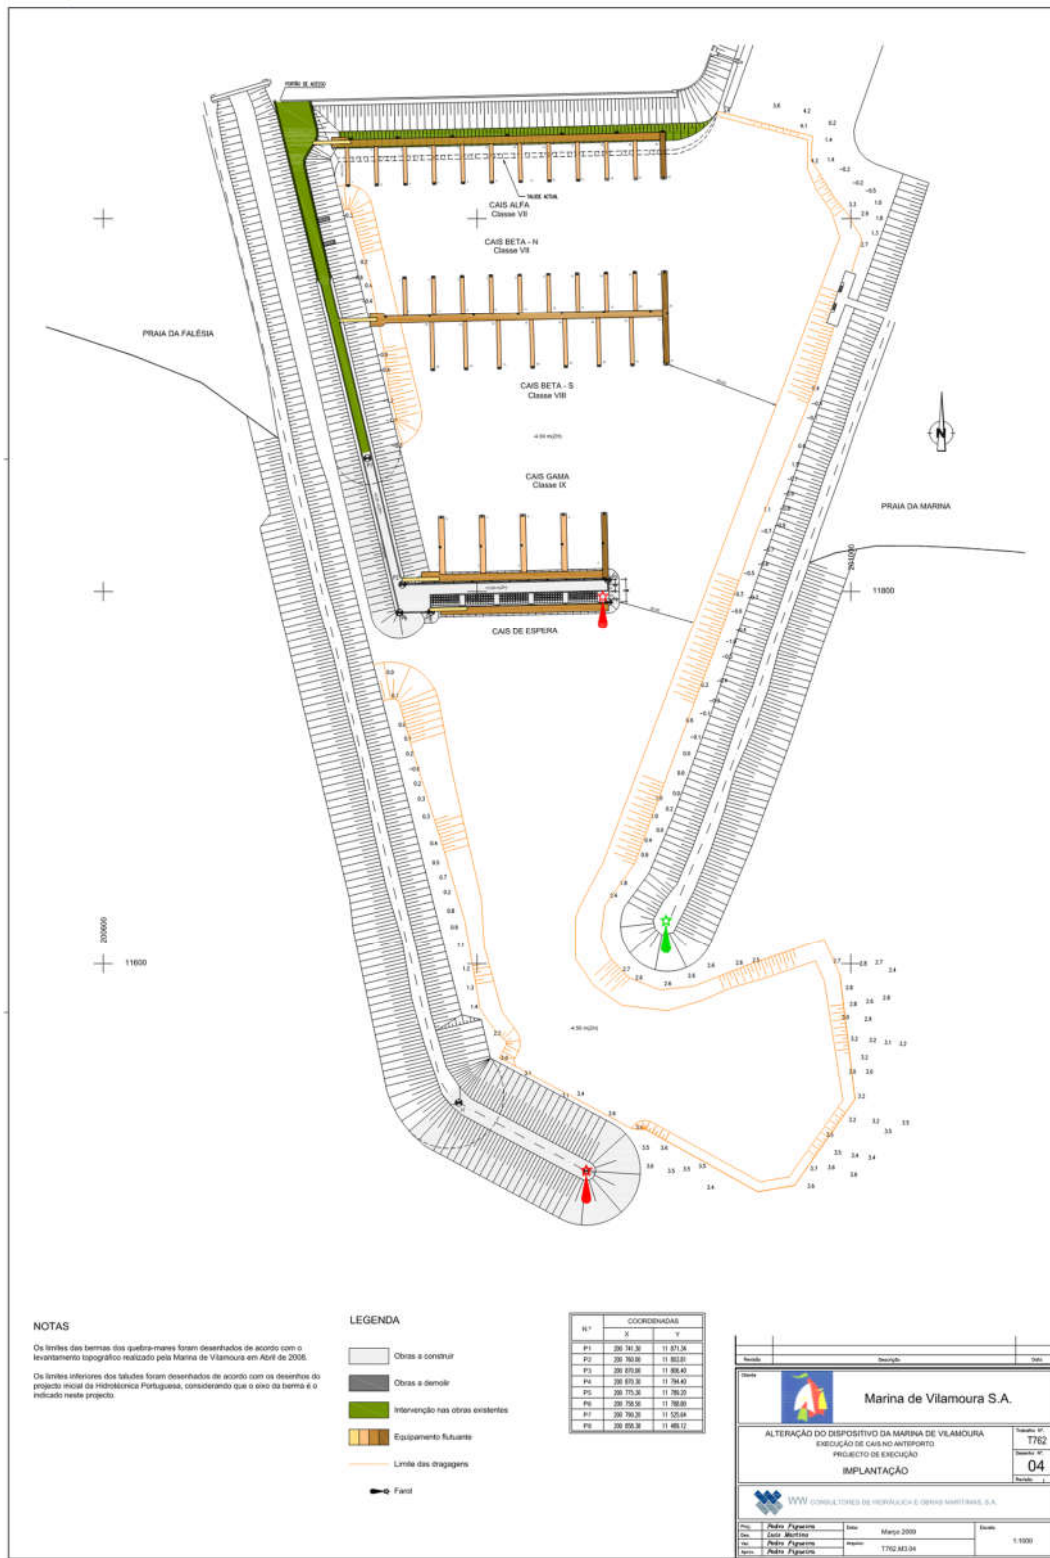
Planta do projeto com implantação da área de dragagem, do prolongamento do molhe e instalação dos cais.
